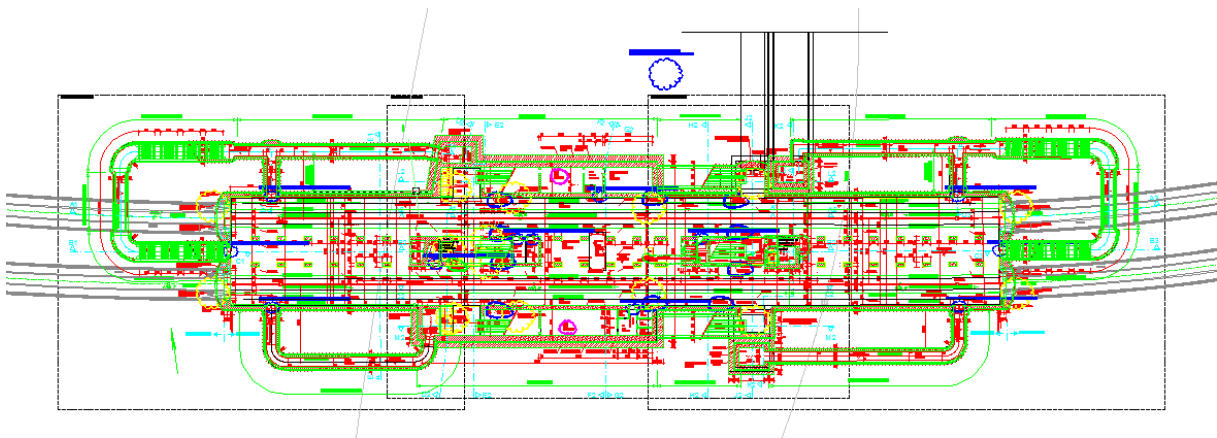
Screenshot aus dem Programm AutoCAD Architecture von Autodesk. Bei dem Plan handelt es sich um den Grundriss der Bahnsteigebenen für die neu geplante Station Marienhof des Planungsbüros Obermeyer.
